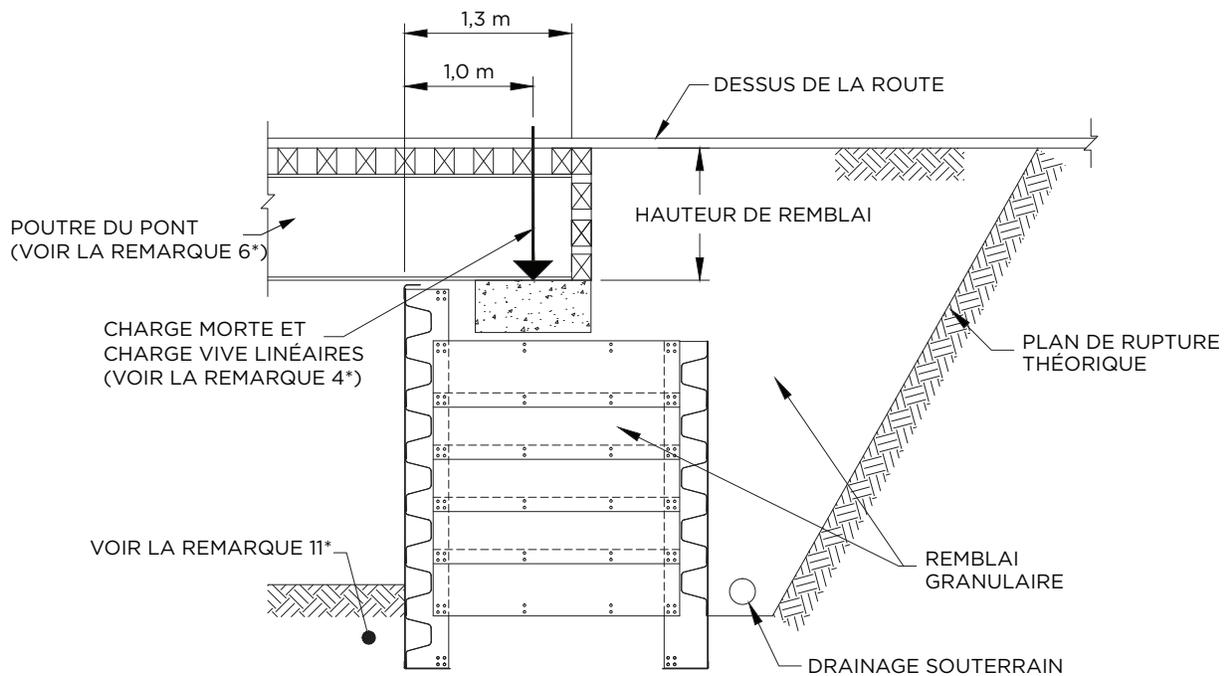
Coupe transversale d'une culée en murs-caissons
